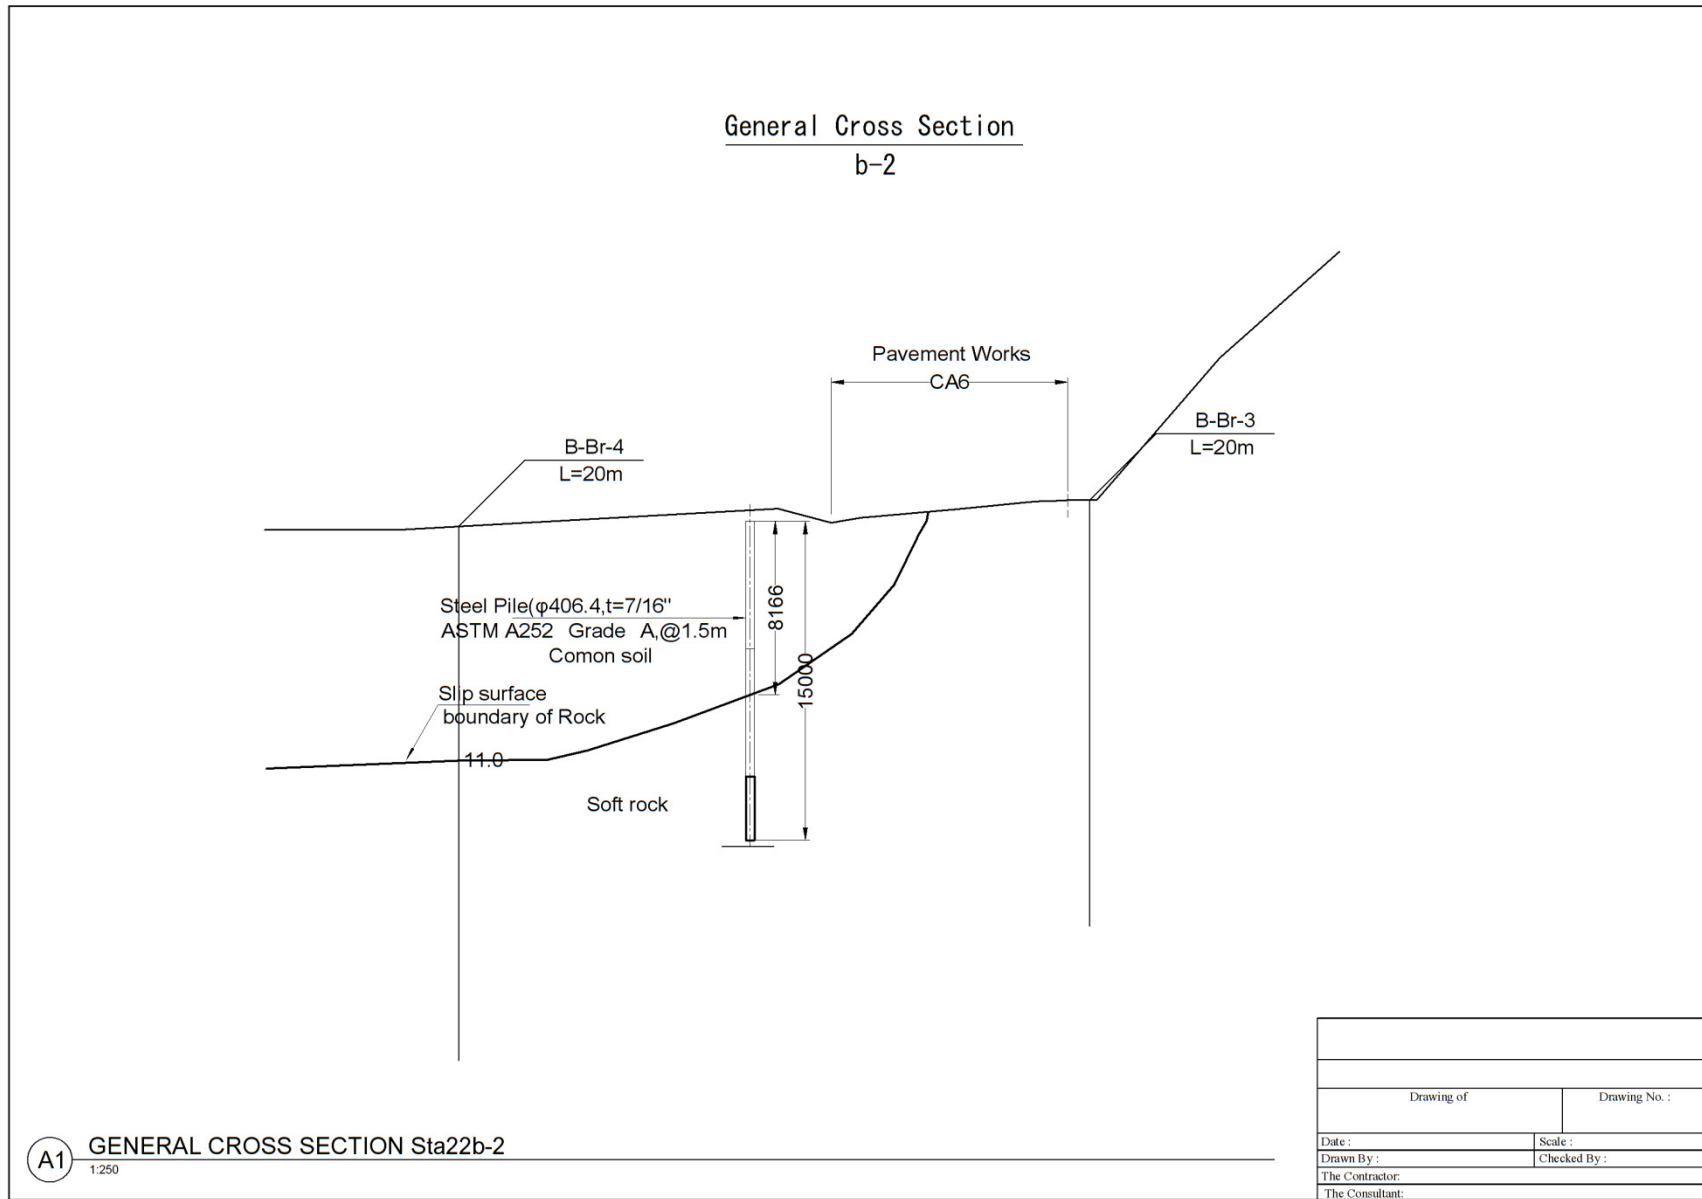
Sta.22 b-2 Vista estándar de la sección transversal (Sin escala)
